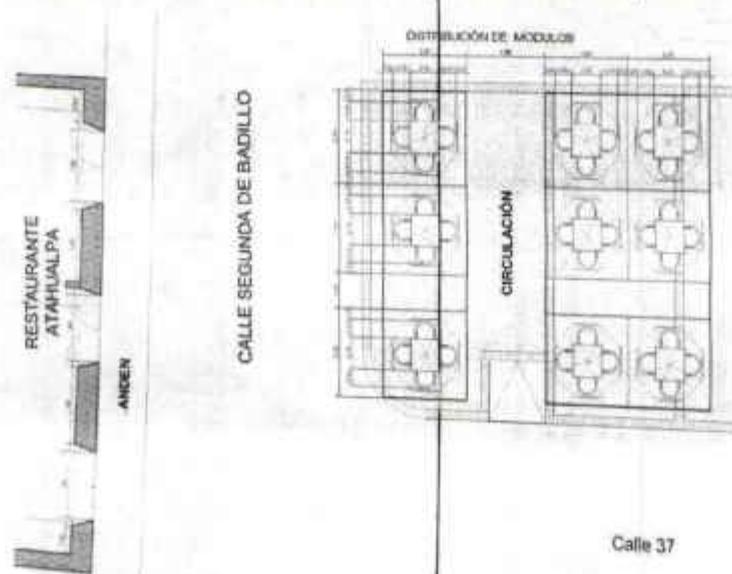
Plano RESTAURANTE ATAHUALPA -Distribución de mobiliario
